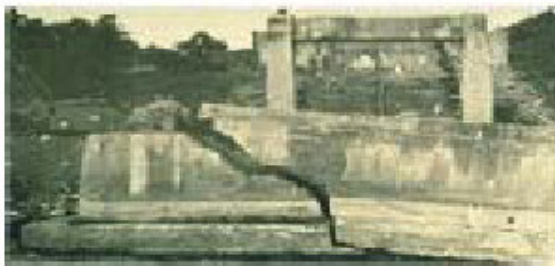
Estruturas de concreto sujeitas ao processo de fissuração
